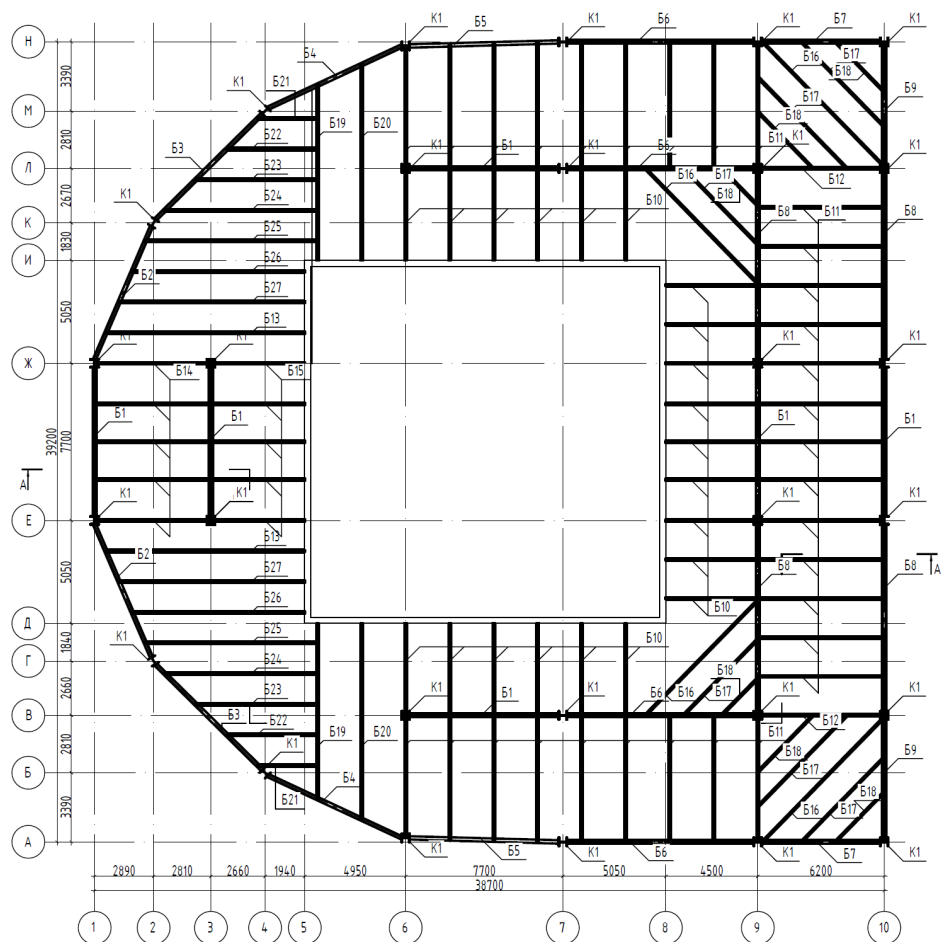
Схема расположения несущих элементов металлического каркаса здания
